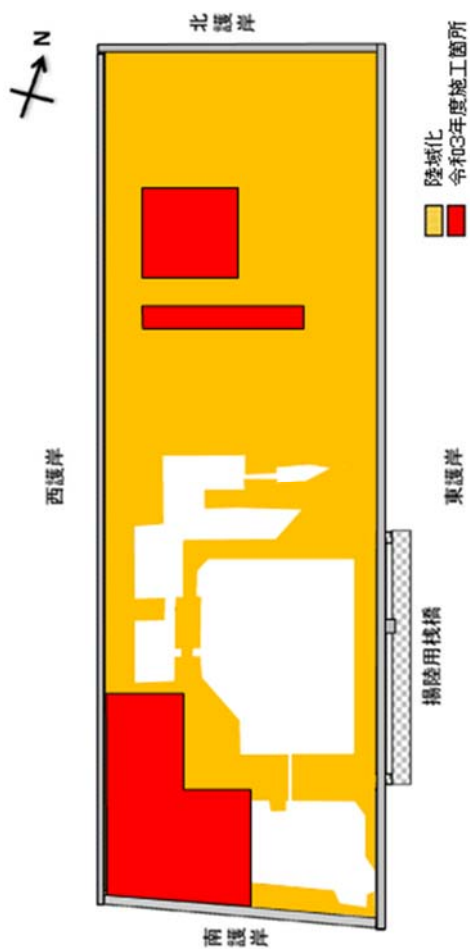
廃棄物埋立場所 (神戸沖埋立処分場) の平面図
